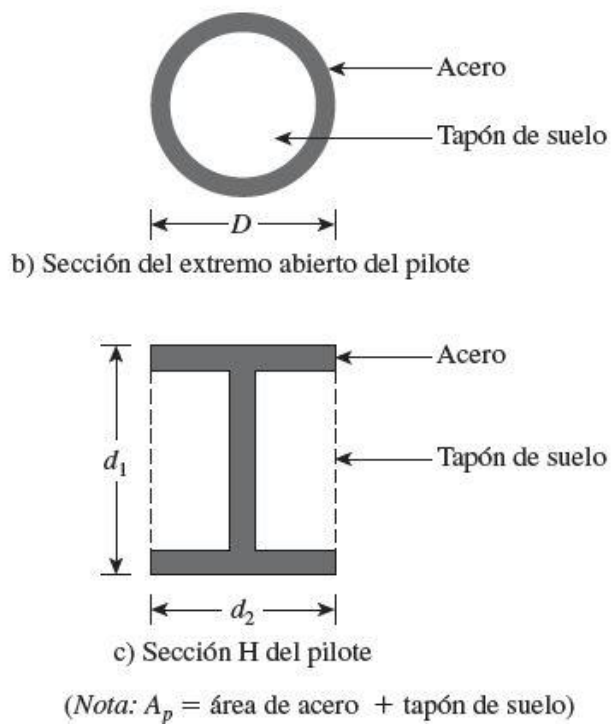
Área de la sección transversal de los pilotes metálicos. Fuente: (Das, 2001)
